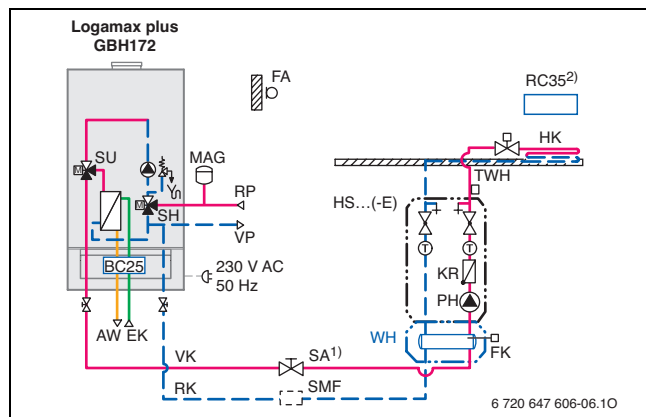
Esempio di un riscaldamento a pavimento non collegato direttamente
